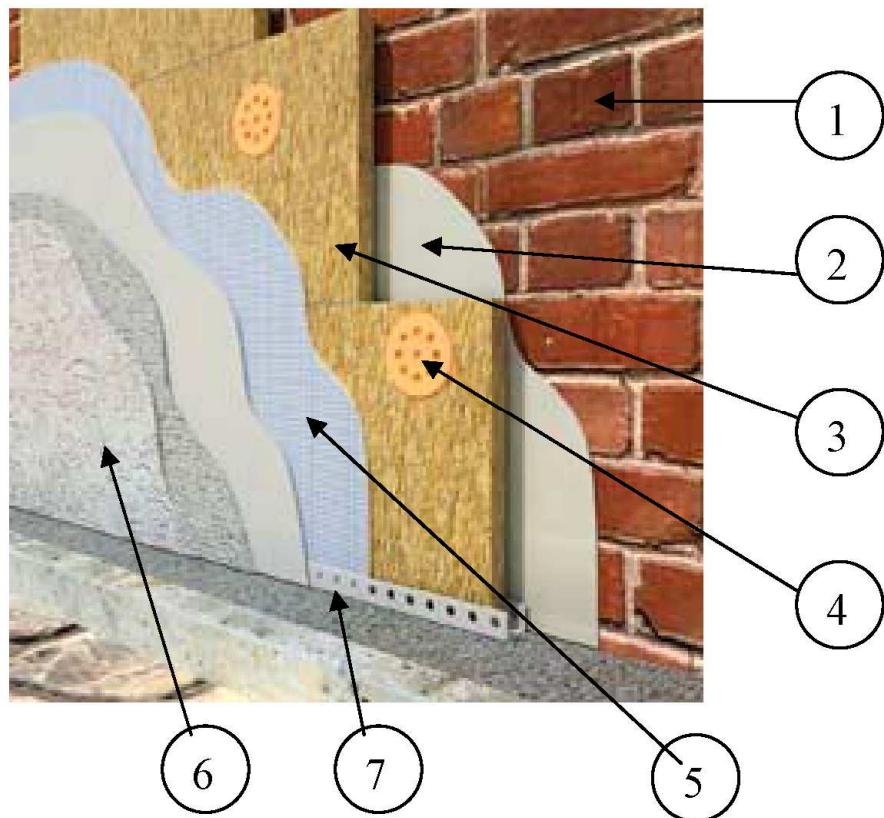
Схема пристрою теплоізоляції способом скріпленої ізоляції: 1 – зовнішня стіна; 2 – ґрунтове покриття; 3 – плита утеплювача; 4 – анкер; 5 – армована сітка; 6 – декоративно-захисний шар; 7 – цокольний профіль
